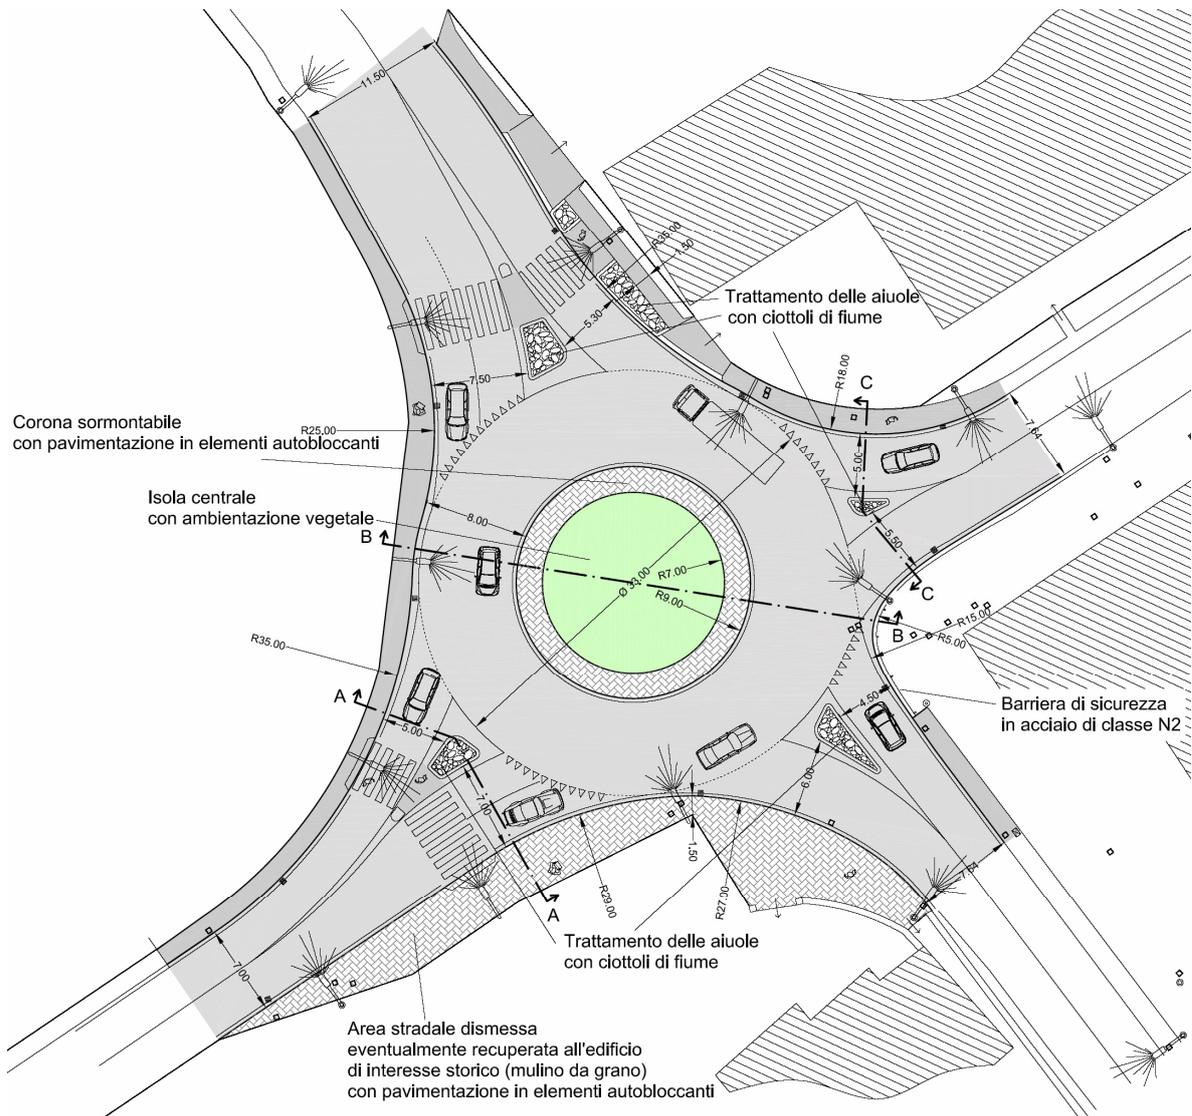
Ipotesi di sistemazione definitiva a rotatoria dell'intersezione di via Lungardo – Sarajevo – Dendrofori
